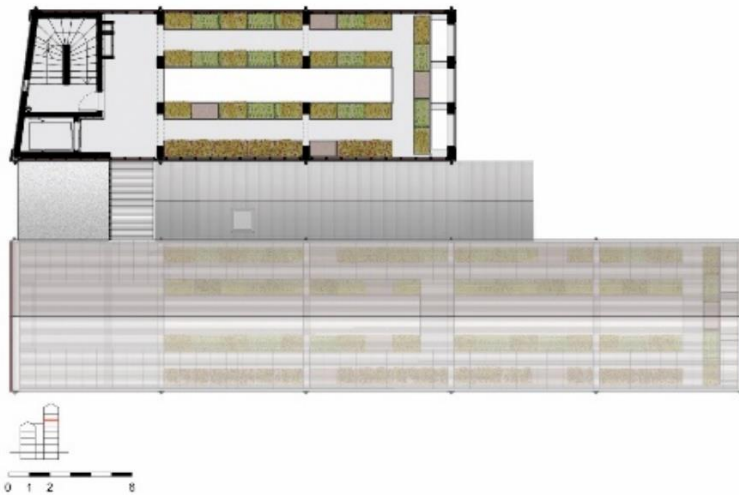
Planta Nivel 3 (fuente: Archdaily.com)
